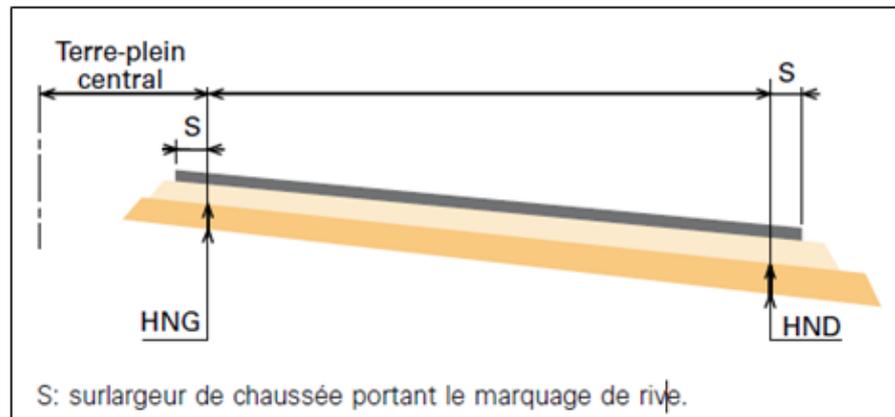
Profil en travers-type d'une chaussée unidirectionnelle
